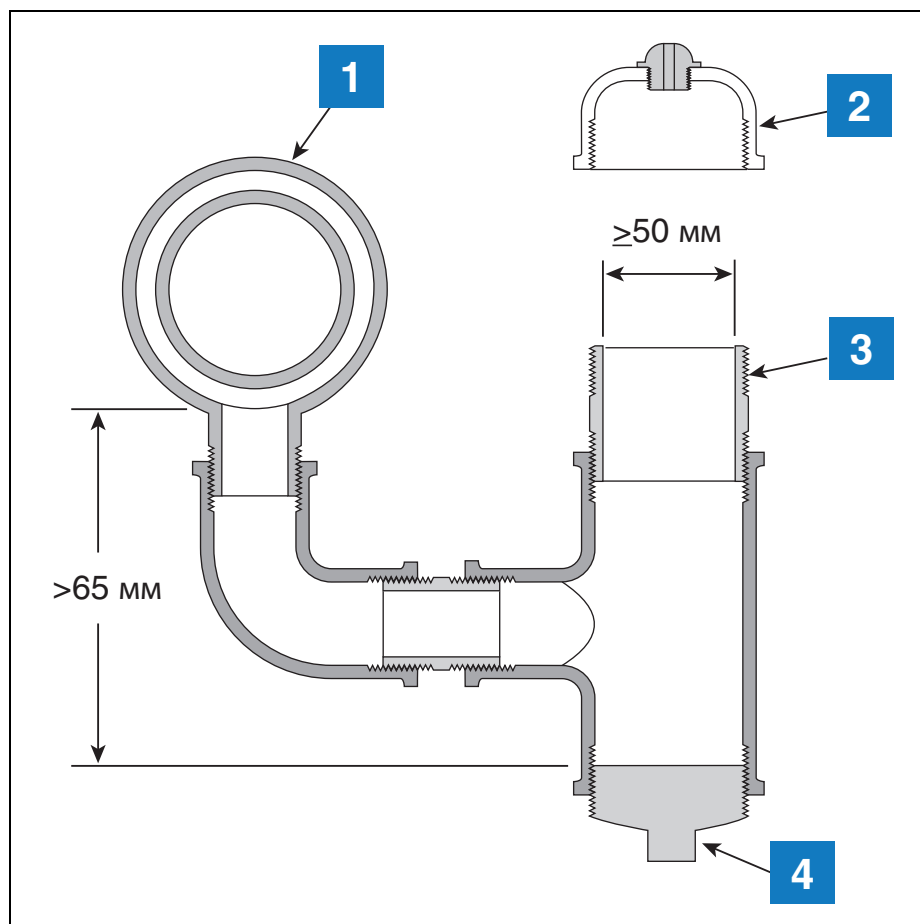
Пример установки сборника трубопровода с двойной обшивкой
